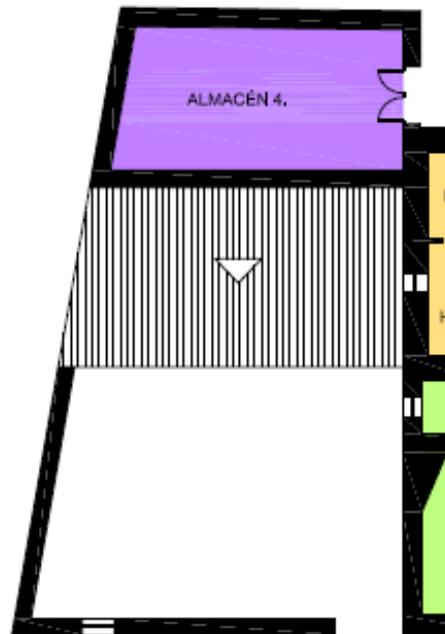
Plano distribución corral ovejas en Planta Primera.
